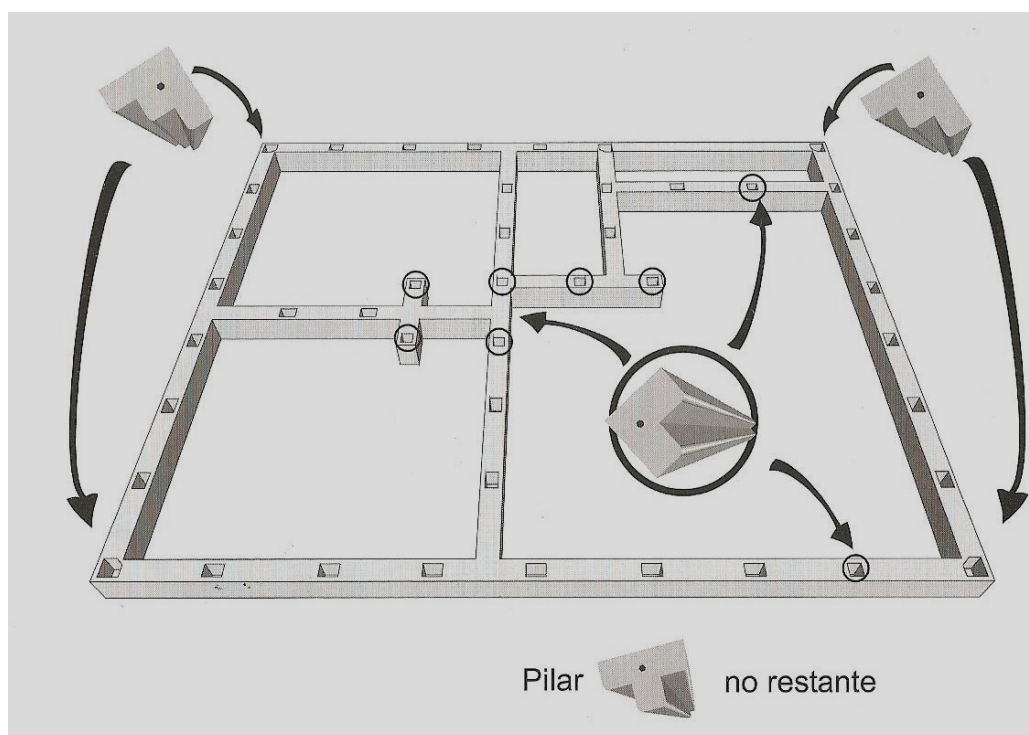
Tipos de pilares e localização no sistema construtivo do protótipo.
